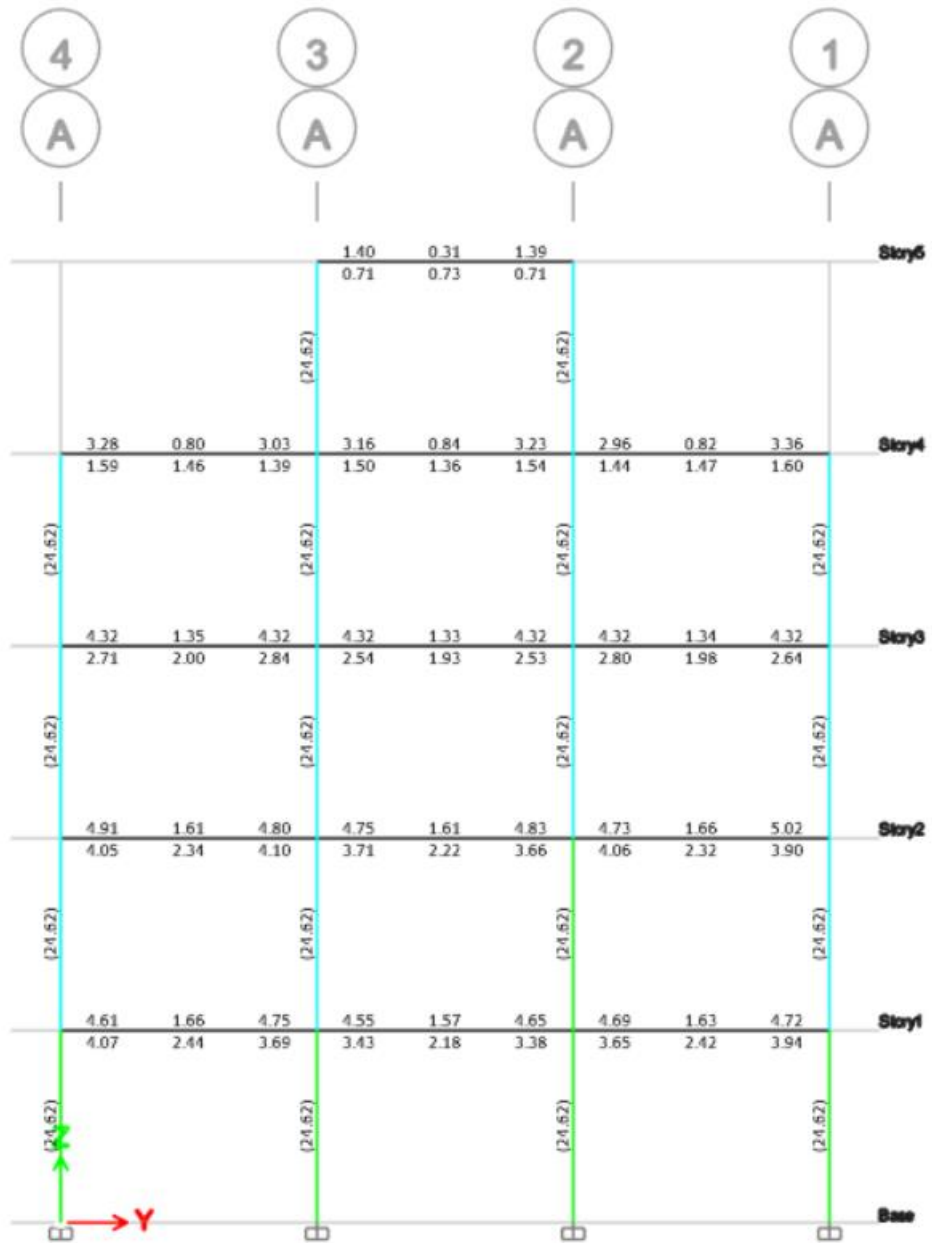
Requerimiento de aceros en vigas, vista en planta.
